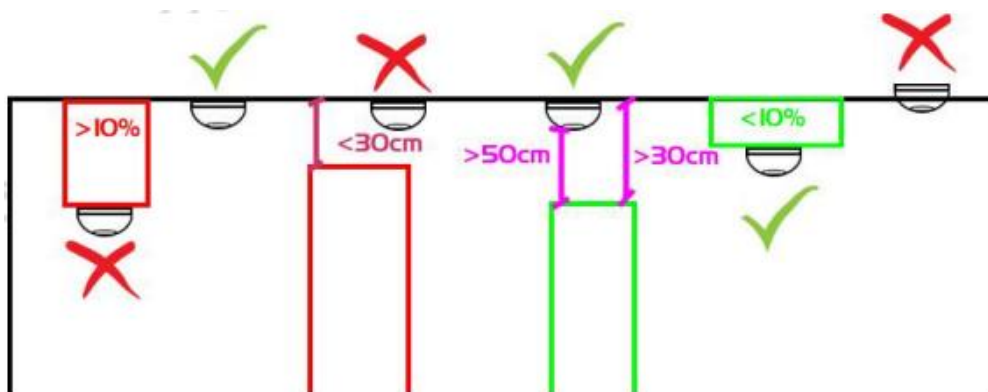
Instalação correta de detetores de incêndio [30]
